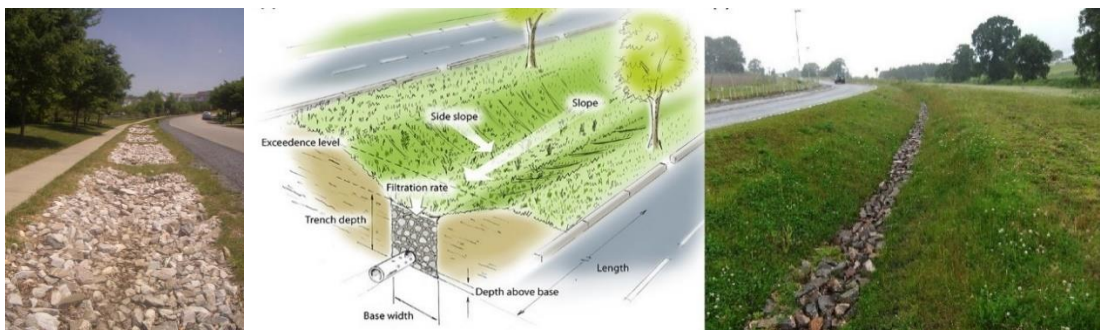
Trincheiras de infiltração. Fonte: (Swales, 2015).
